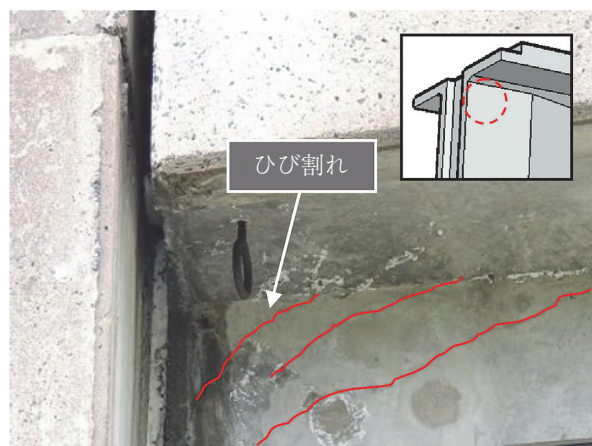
主桁フランジ・ウェブ近傍のひび割れ
